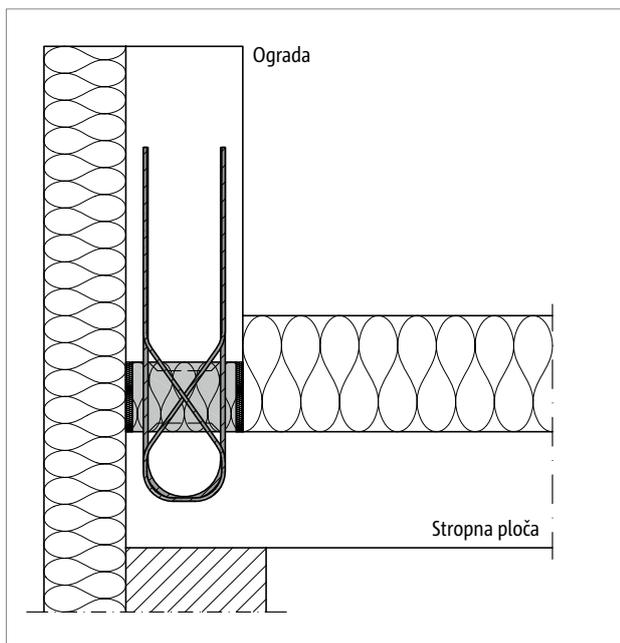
Schöck Isokorb® XT/T tip AP vertikalna ugradnja: Pogled, parapet na ploči
